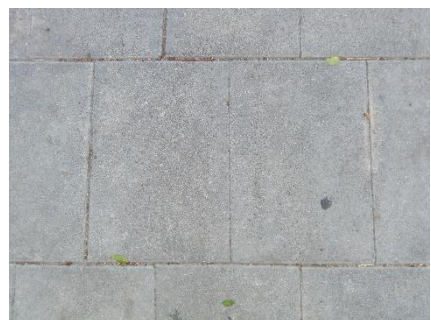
pavimento zona central de la plaza Olof Palme .
